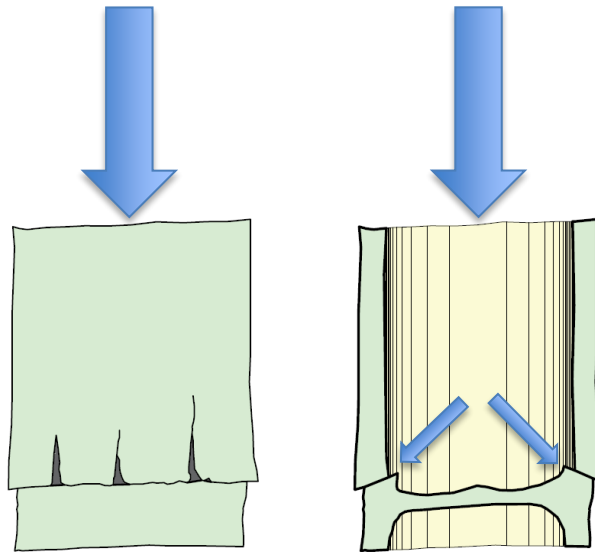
Fallas en el bambú “Pandeo local de las fibras”.
